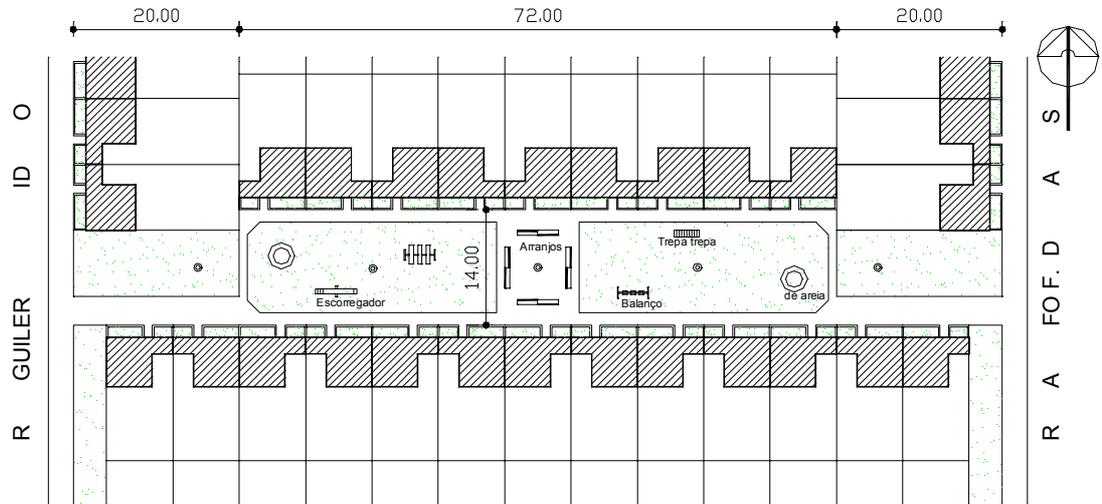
Planta Original do Espaço Aberto Comum 1 do CHST
